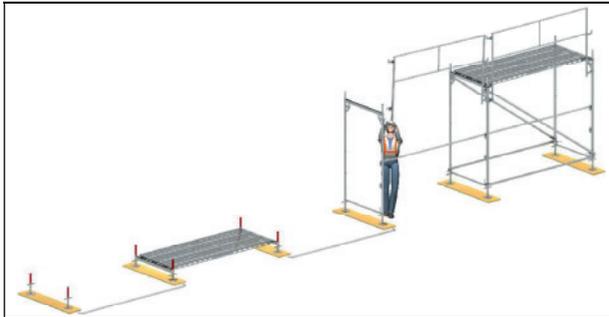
Montage des I-Geländers im zweiten Gerüstfeld
